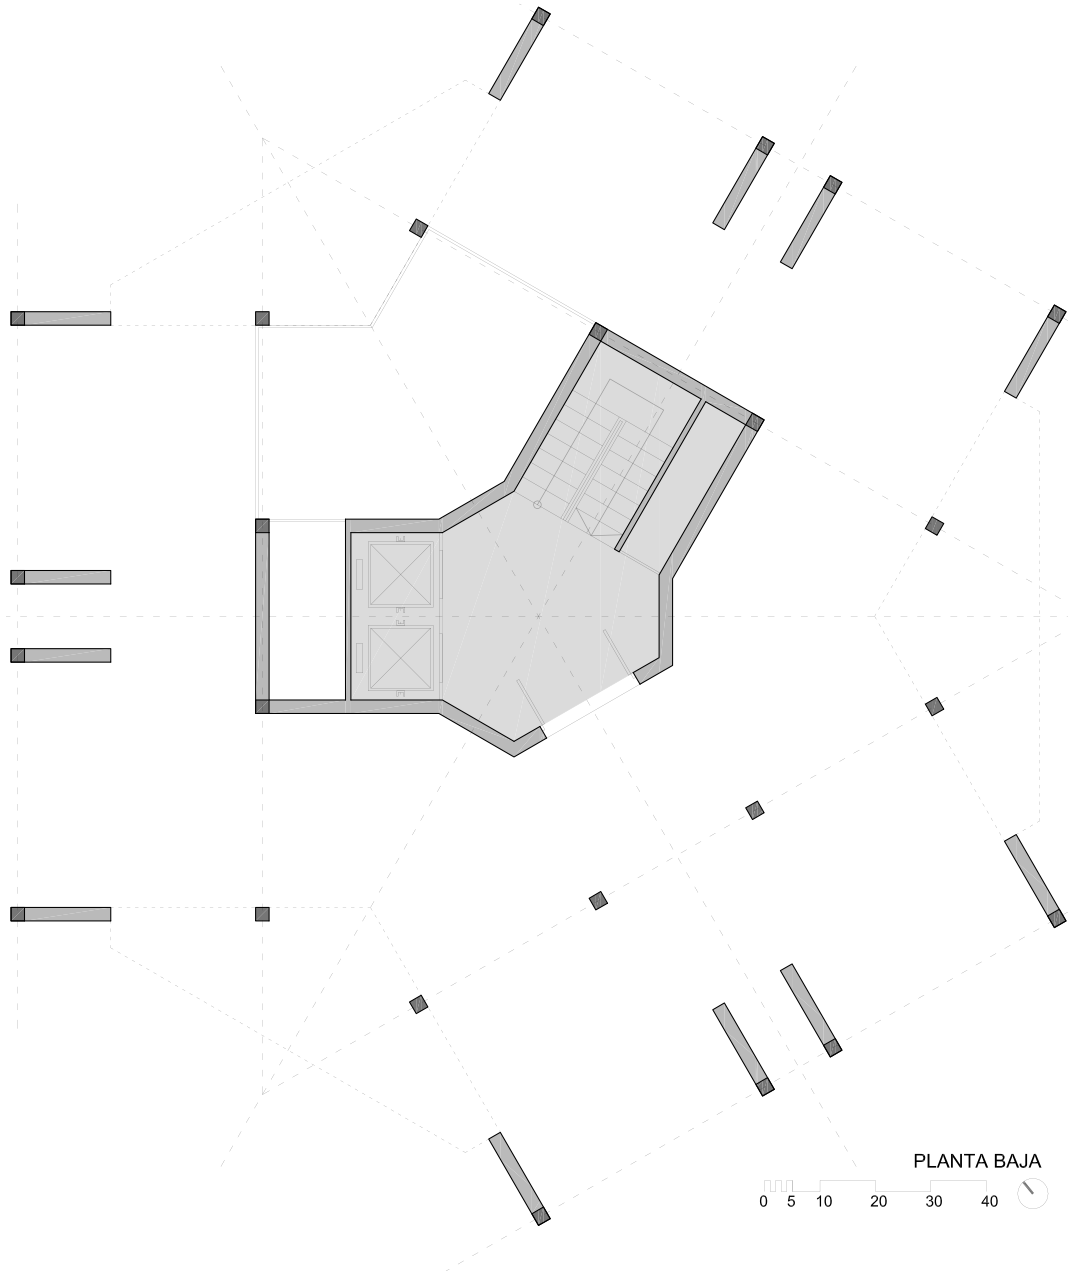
Planta baja de la Torre Hexagonal. Elaboración propia
